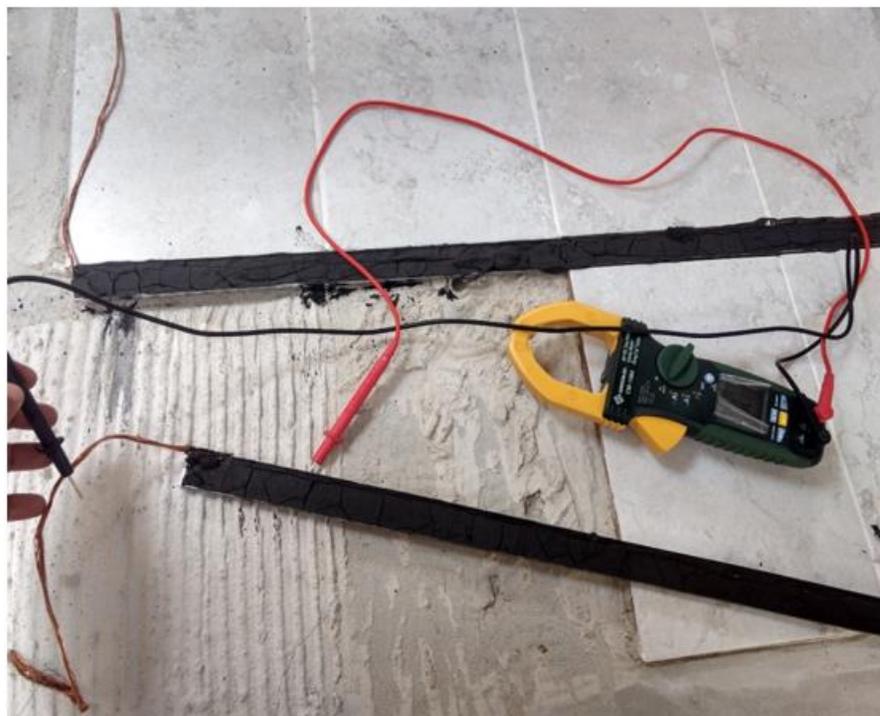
Medición de la continuidad eléctrica entre perfiles posterior a la instalación.
